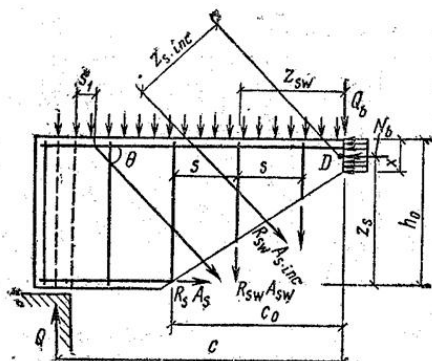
Расчетная схема усилий в наклонном сечении
